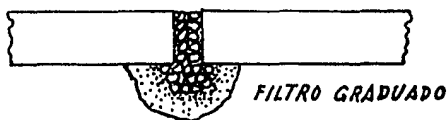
Lloradero en el Revestimiento de Concreto con Filtro por debajo.
